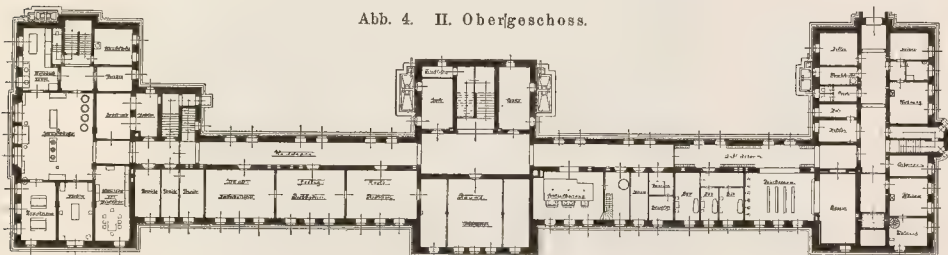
4. Grundriss des Internatsgebüdes.
